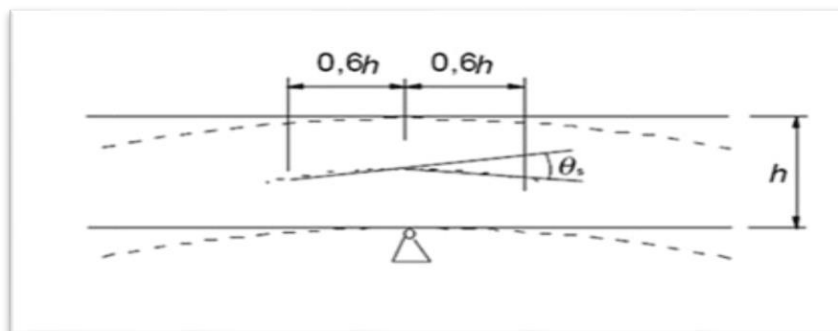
rotation plastique d'une section droite de béton armé dans le cas d'une poutre ou d'une dalle continue portant dans une seule direction. [7]
